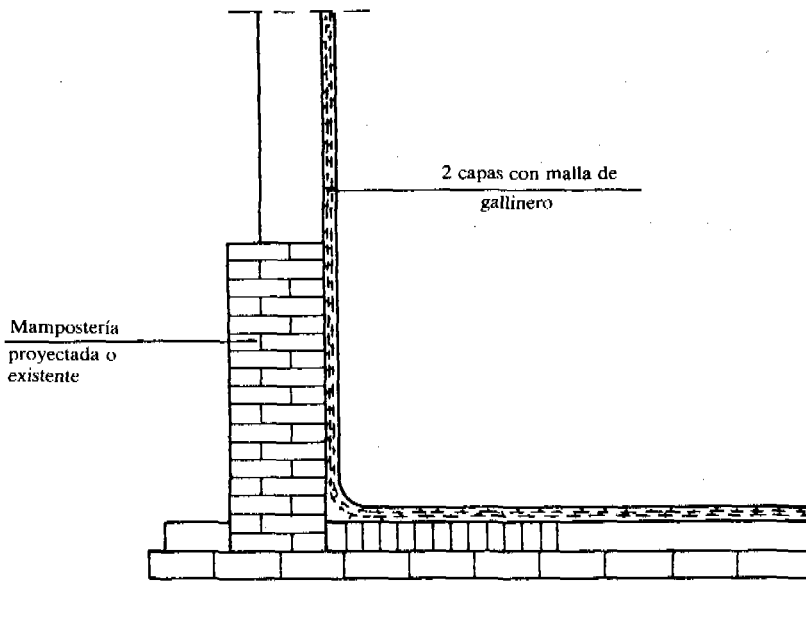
Sección transversal de la pared de un filtro construida de mampostería y ferrocemento.
